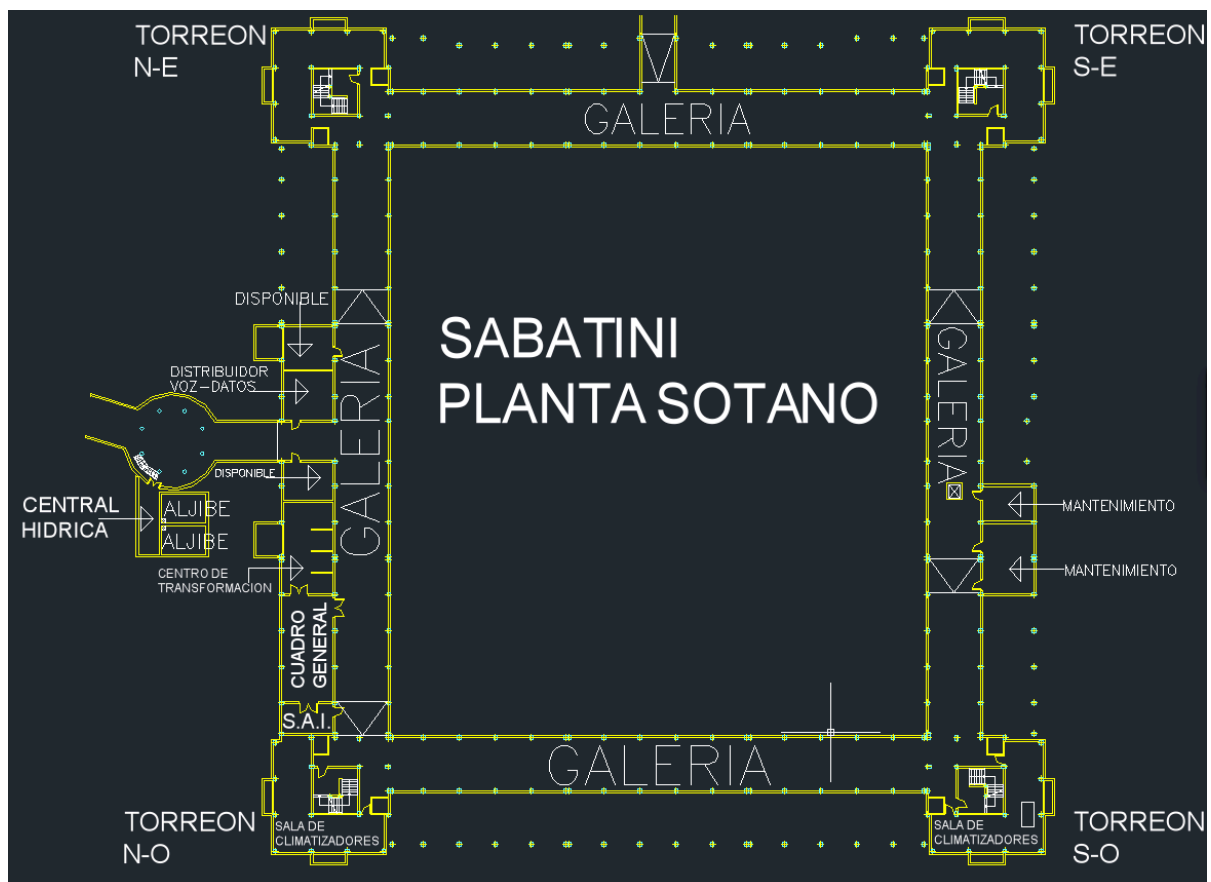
Vista en planta del Sótano, edificio Sabatini - AutoCAD
